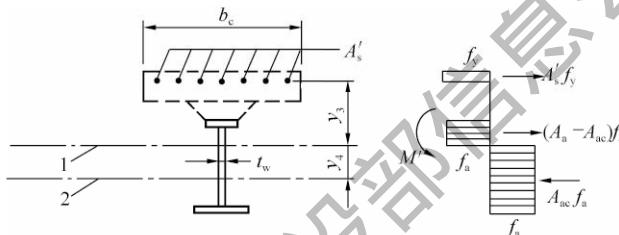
负弯矩作用时组合梁截面和计算简图
